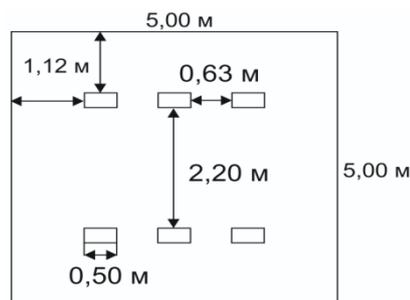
План помещения и размещения светильников с люминесцентными лампами
